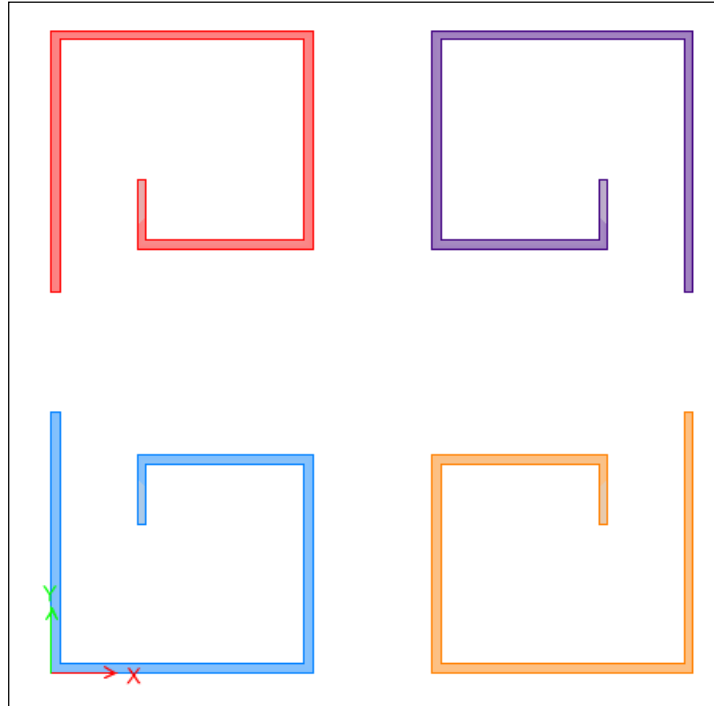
Vista en planta del Edificio F (elementos tipo barra de sección transversal irregular)
